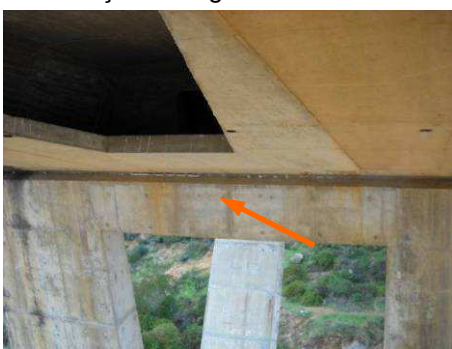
Fissuração longitudinal na laje do banzo inferior (Tramo Central)
